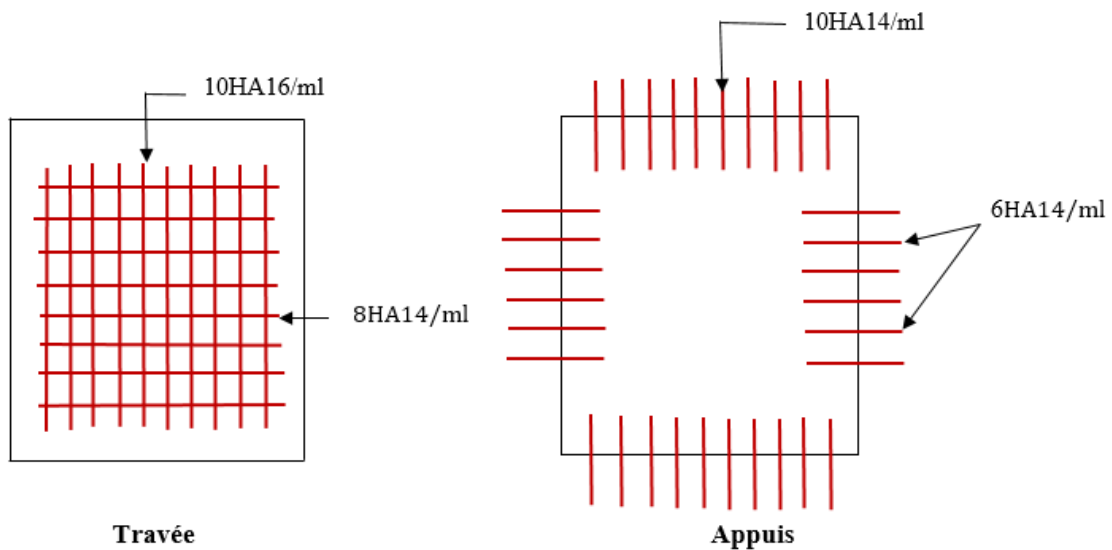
Schéma de ferrailage d'un panneau intermédiaire .
